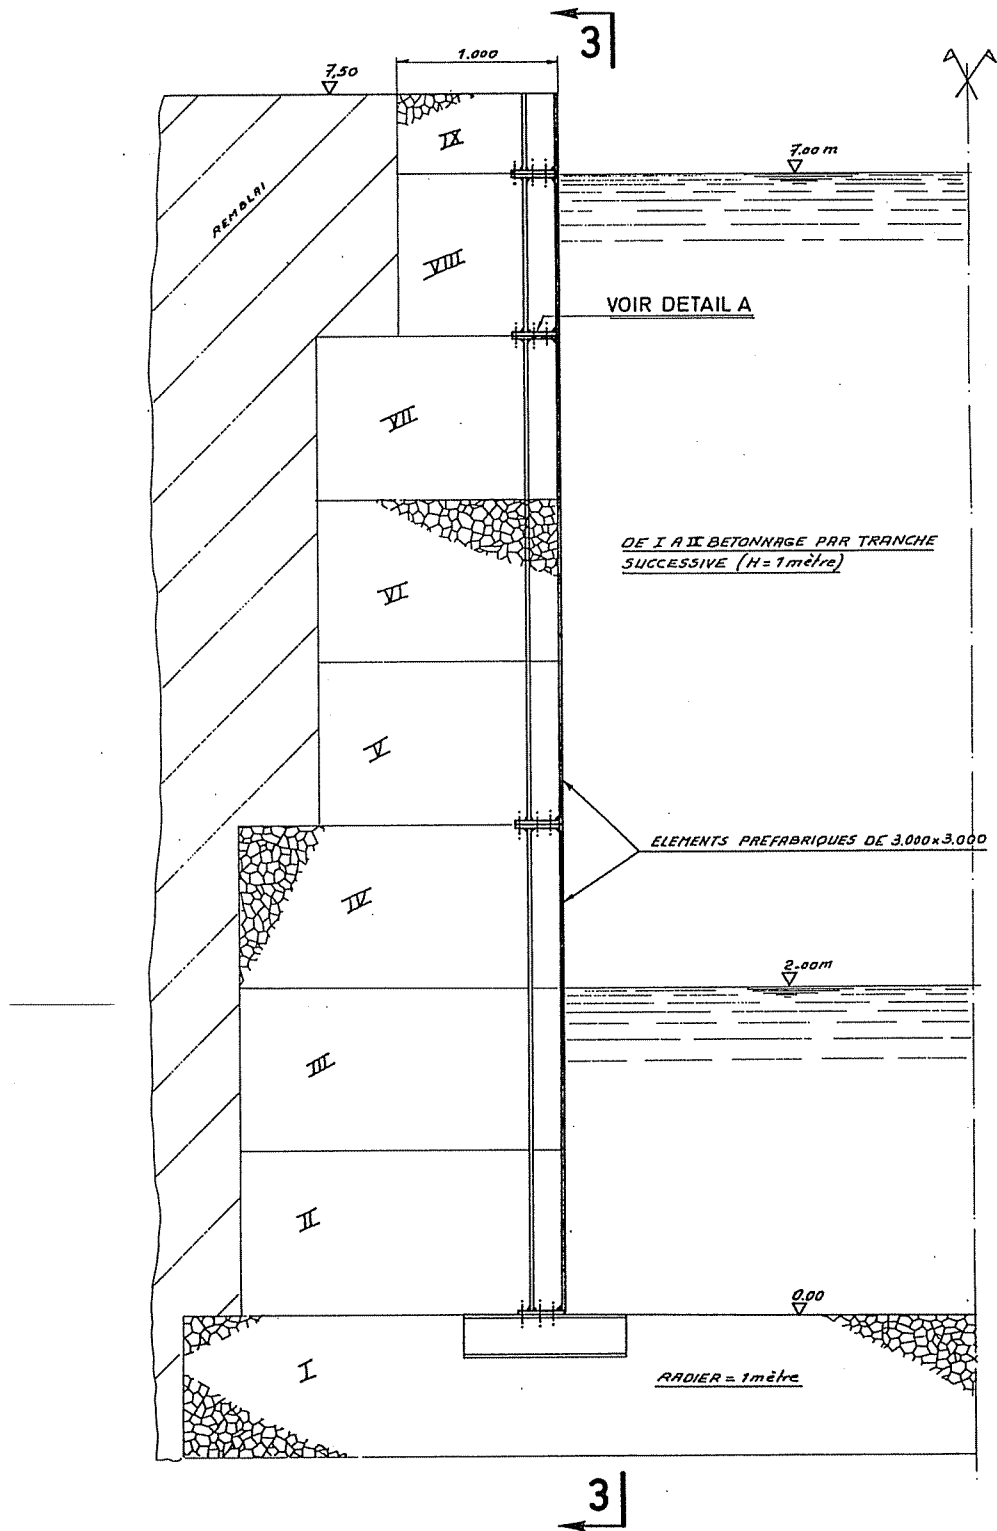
Plans et coupes dans la tête et la porte amont.
